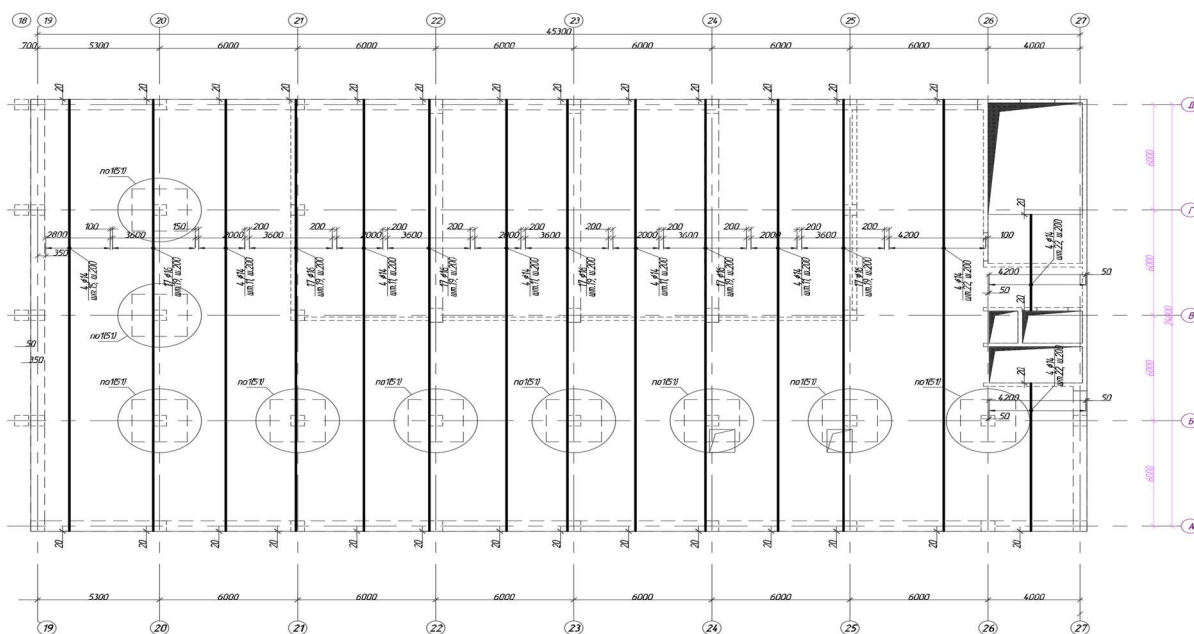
Схема расположения основной и дополнительной нижней арматуры вдоль цифровых осей
